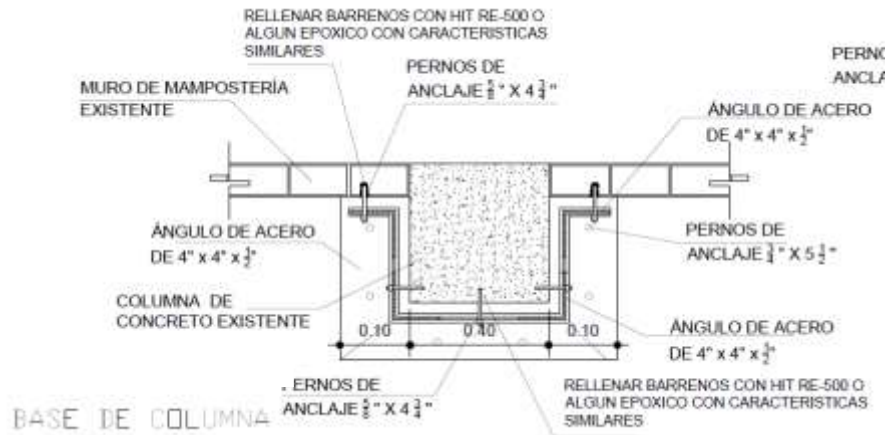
Detalle de refuerzo de columnas perimetrales de sótano, planta baja, primer y segundo nivel, Proyecto estructural.
